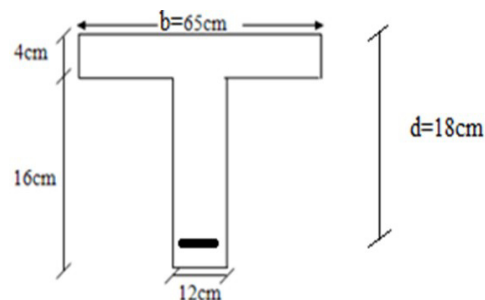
Schéma des dimensions pour le ferrailage des poutrelles
